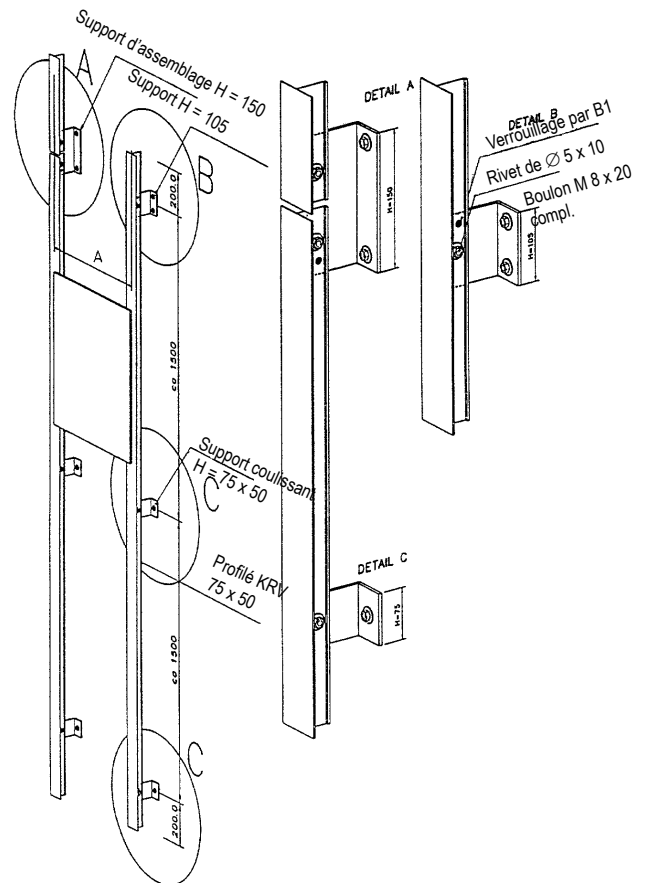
Système de profilés en aluminium du type KRV : montage.
